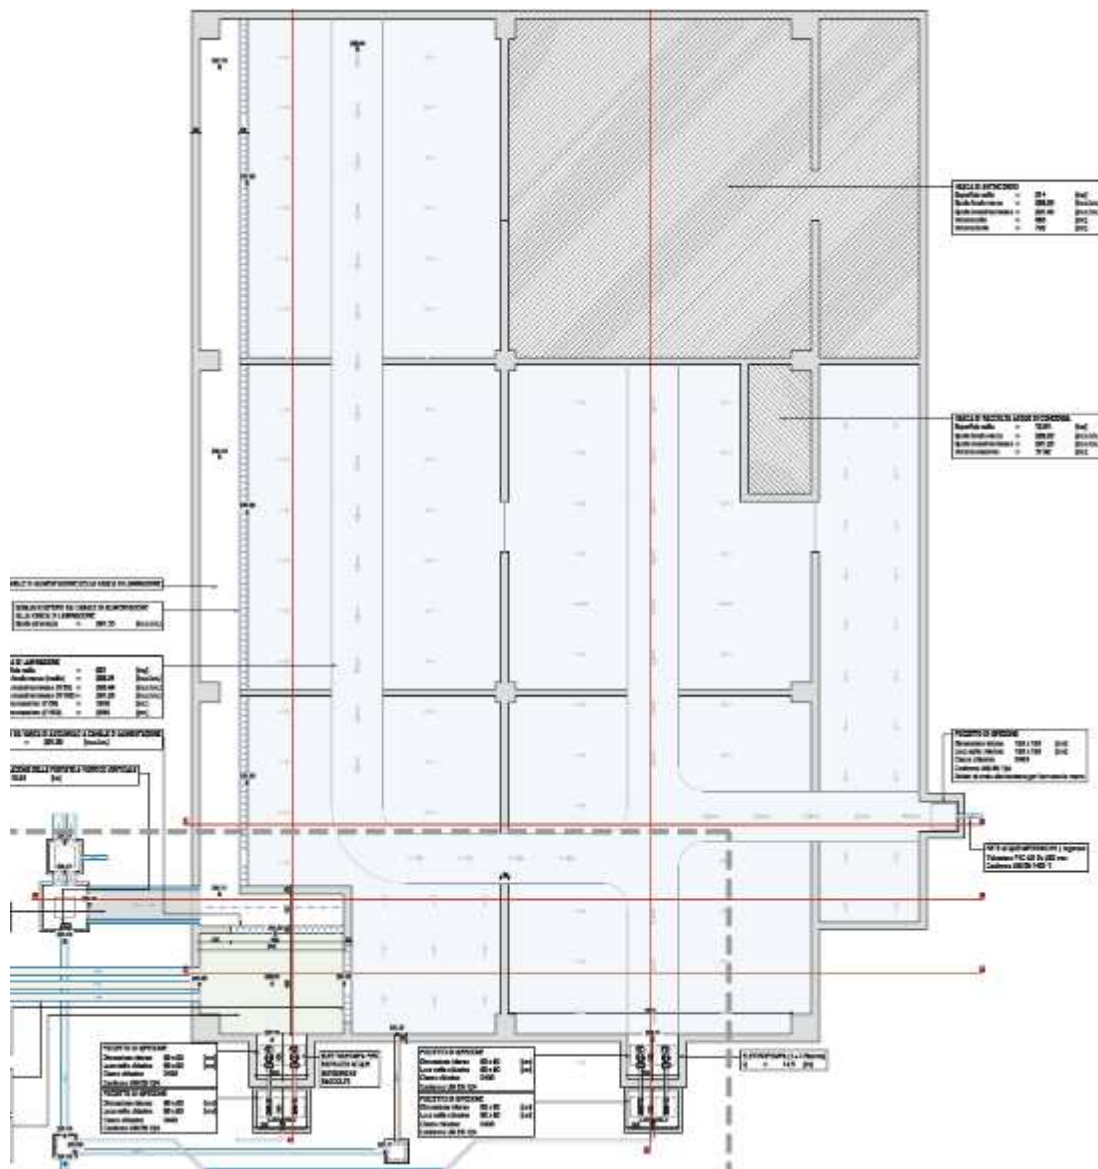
Planimetria vasca di laminazione estratta dall'elab. 00PC_OU_N003_4929
